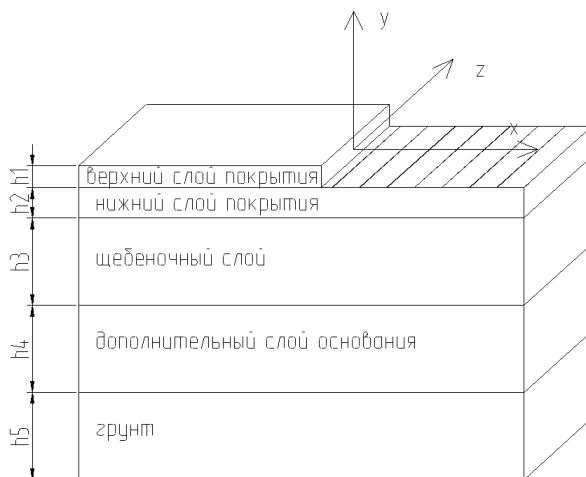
Расчетная схема «покрытие–основание дороги»
